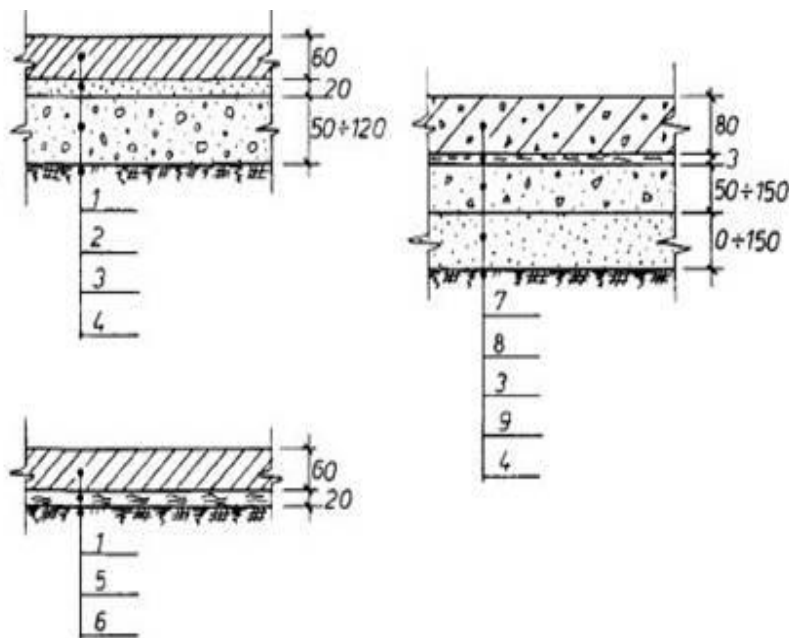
Схемы конструкций неводостойких покрытий для различных подстилающих грунтов (размеры в мм). 1 – спецсмесь; 2 – щебень фракции 3 – 5мм; 3 – щебень фракции 5 – 40 мм; 4 – уплотненный подстилающий грунт (глины, суглинки, супесчаные и песчаные грунты); 5 – торф; 6 – уплотненный подстилающий грунт (гравелистый); 7 – гранитные высевки фракции 2 – 5 мм; 8 – сетка полиэтиленовая; 9 – песок. Толщина слоя щебня принимается: на глинах и суглинках – 120 мм, на песчаных и супесчаных грунтах – 50 мм, при различных коэффициентах фильтрации (КФ) подстилающего грунта толщина слоя щебня и песка принимаются: при КФ более 500 мм/час слой щебня 50 мм, слой песка отсутствует, при КФ от 100 до 500 мм/час соответственно по 100 мм; при КФ до 100 мм/час соответственно по 150 мм
